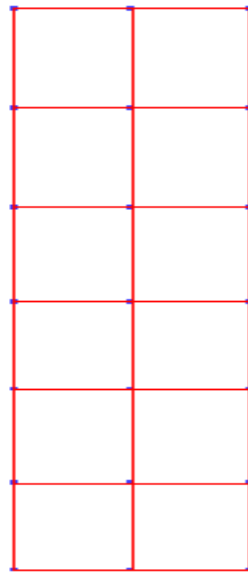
Vista en planta de columnas y vigas graficadas en el software ETABS.
